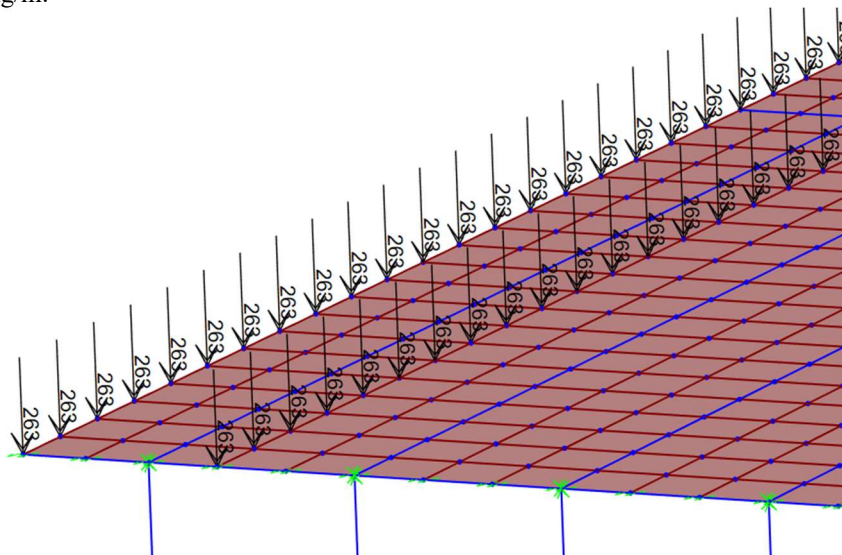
Aplicación de la carga muerta DC\_Barreras de barreras
